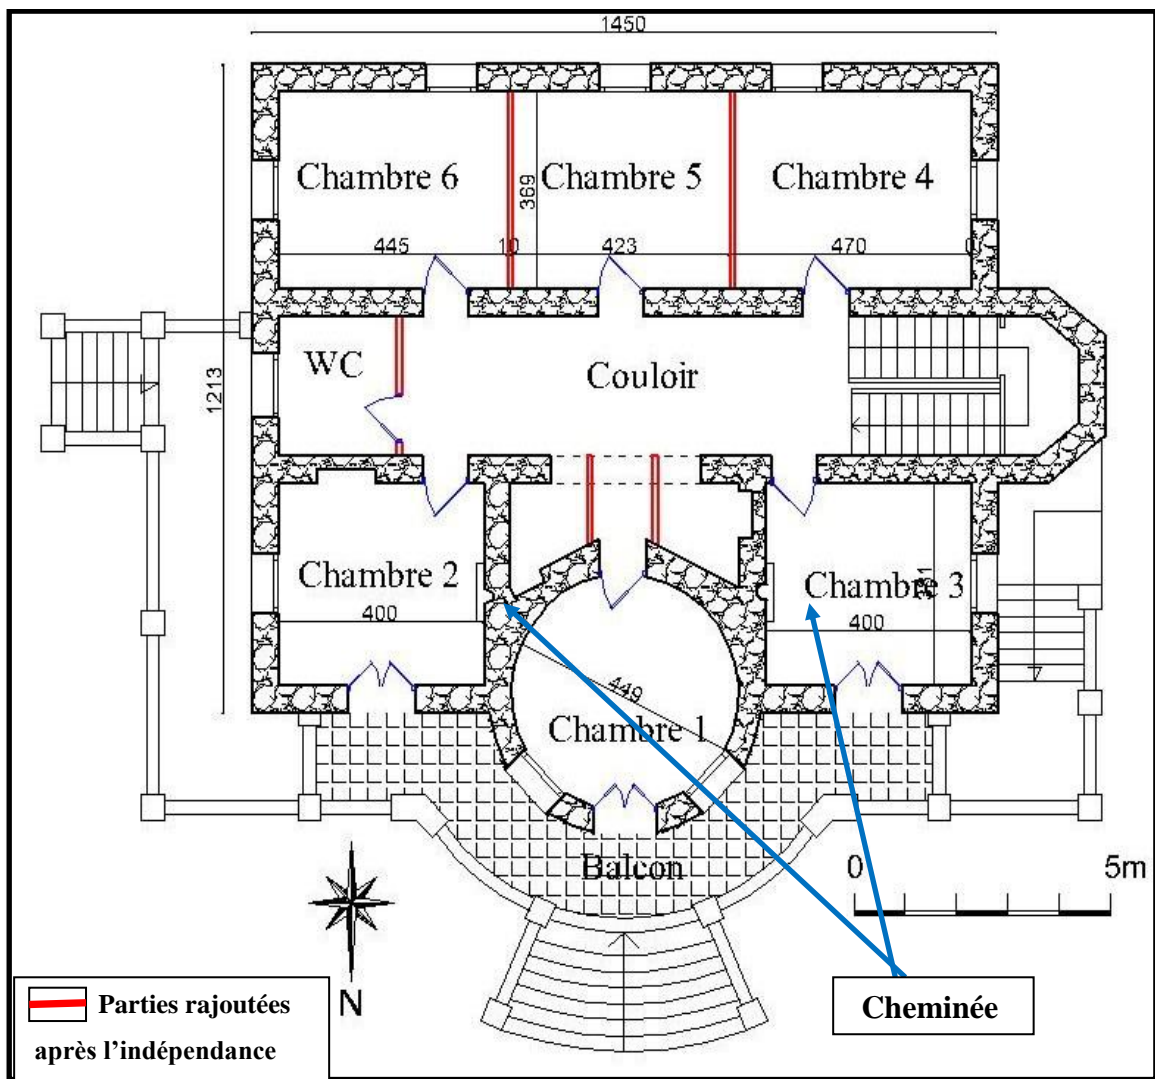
32: Plan du 1^{er} étage du bâtiment principal.
